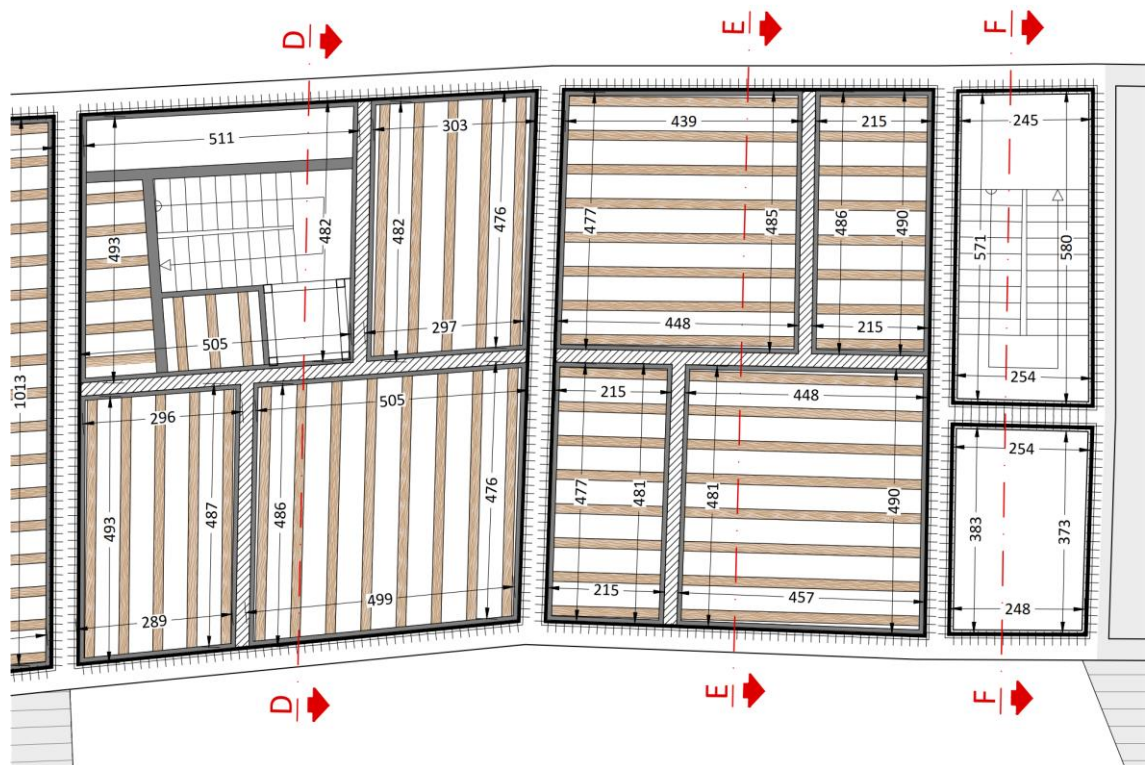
Pianta solaio piano primo dei blocchi D,E,F
